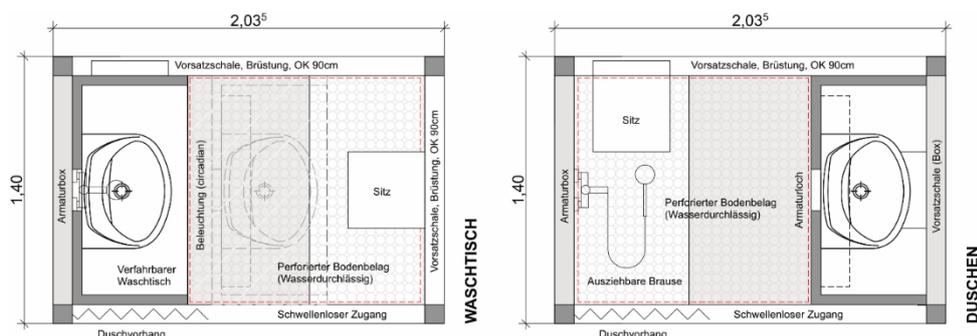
Grundrissdarstellung, Konzeptstatus-03
